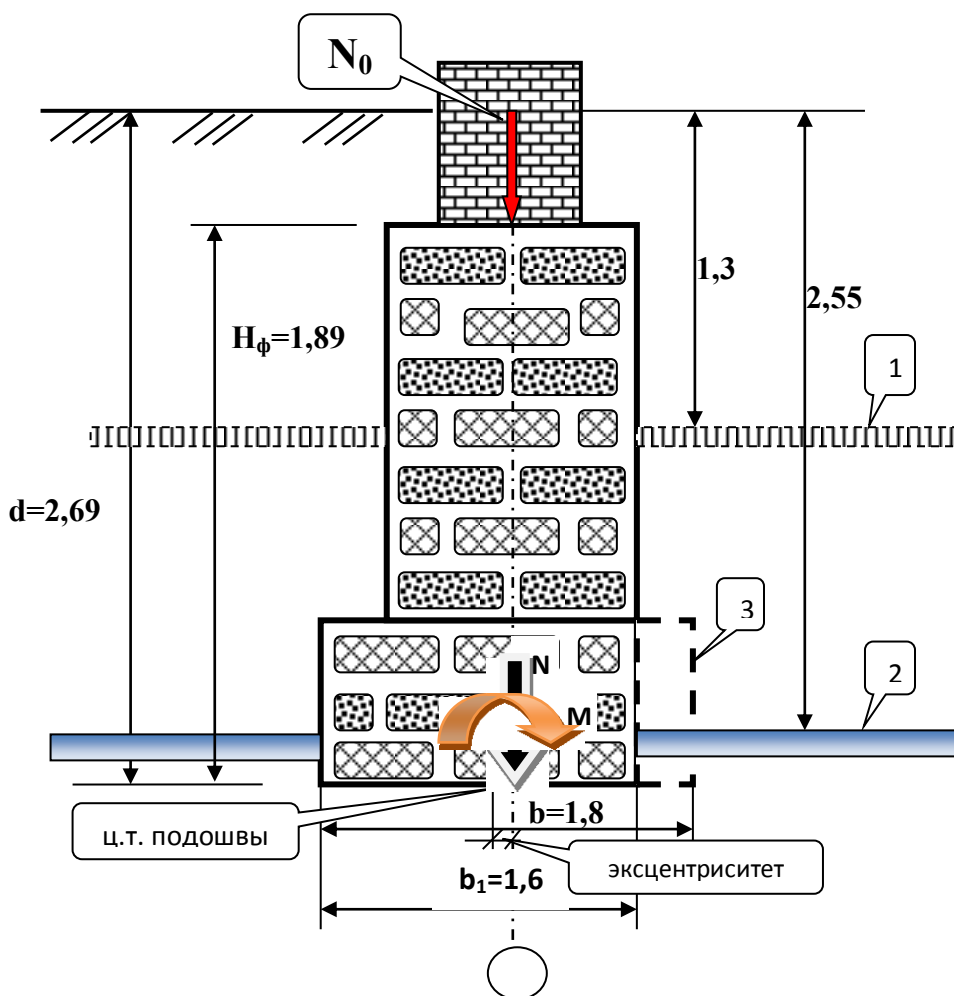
Схема поперечного сечения фундамента реконструируемого здания для расчётного обоснования возможности понижения отметки пола существующего подвала, и частичной подрезки подошвы фундамента.
